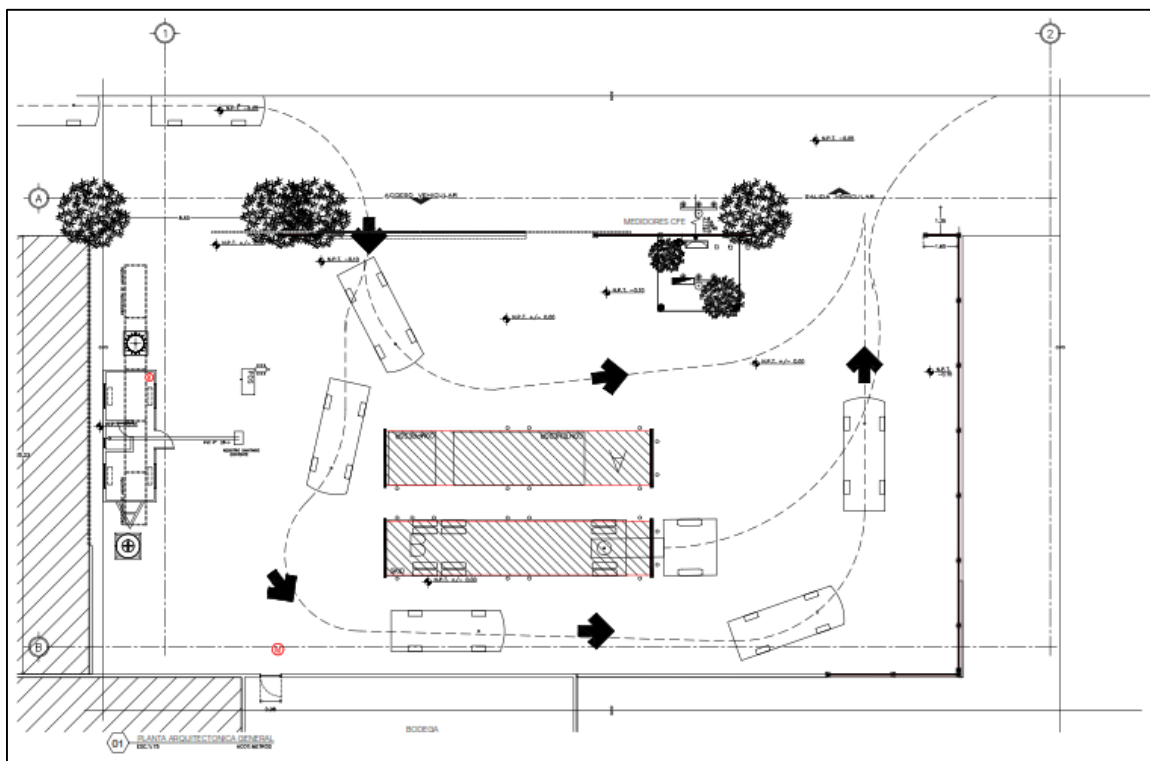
Plano donde se observa el acceso terrestre a la instalación de la UMD.
